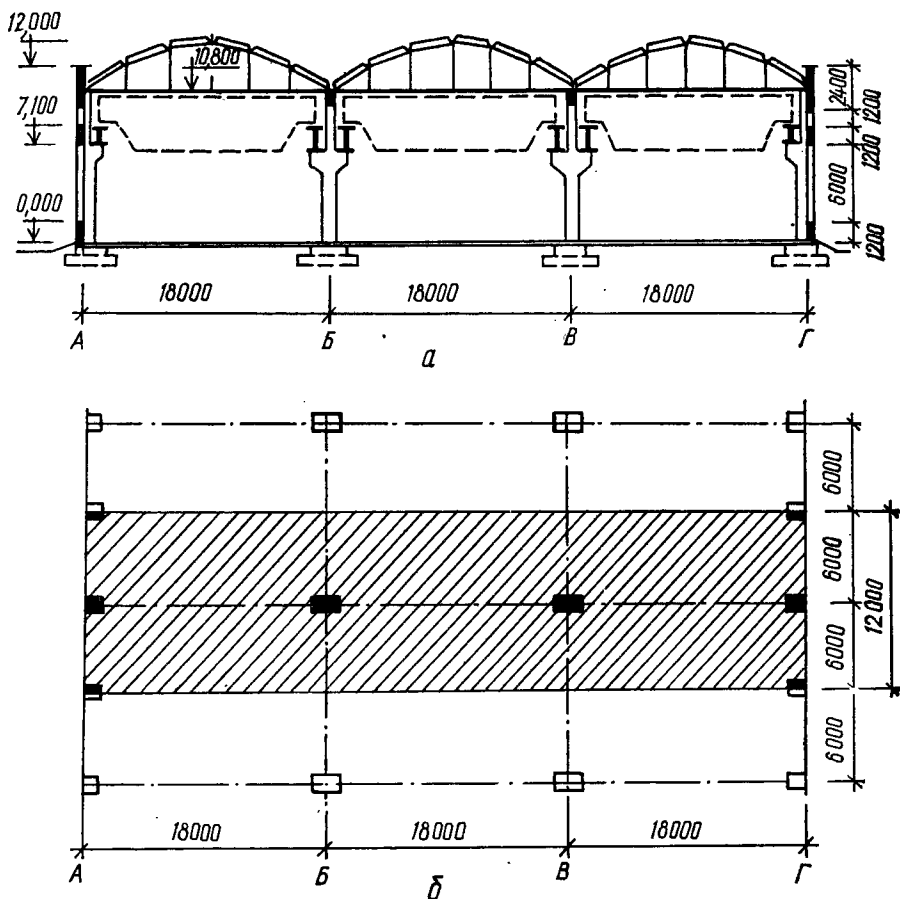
Поперечная рама одноэтажного промышленного здания и фрагмент плана:
